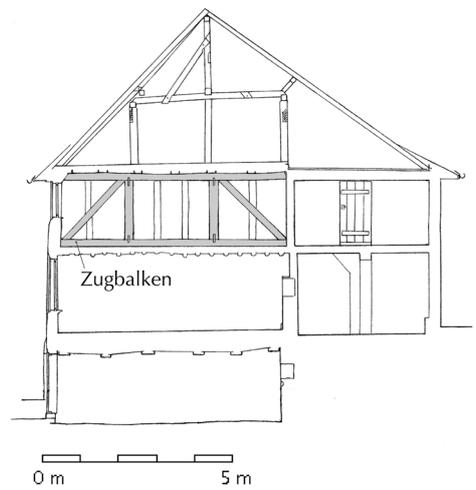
Nachträglich über einer Balken-Bretter-Decke ausgeführte Wand mit integriertem, abgesprengtem Hängebund (grau). Wollmatingen, Sternengasse 4, 19. Jh.
